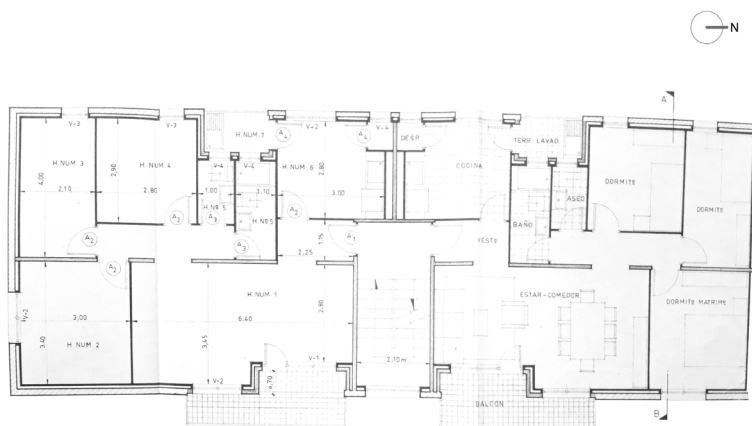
Plano de la planta tipo del edificio ubicado en la Rúa Vilagarcía-Arousa, nº6 (fotografía de autoría propia).
